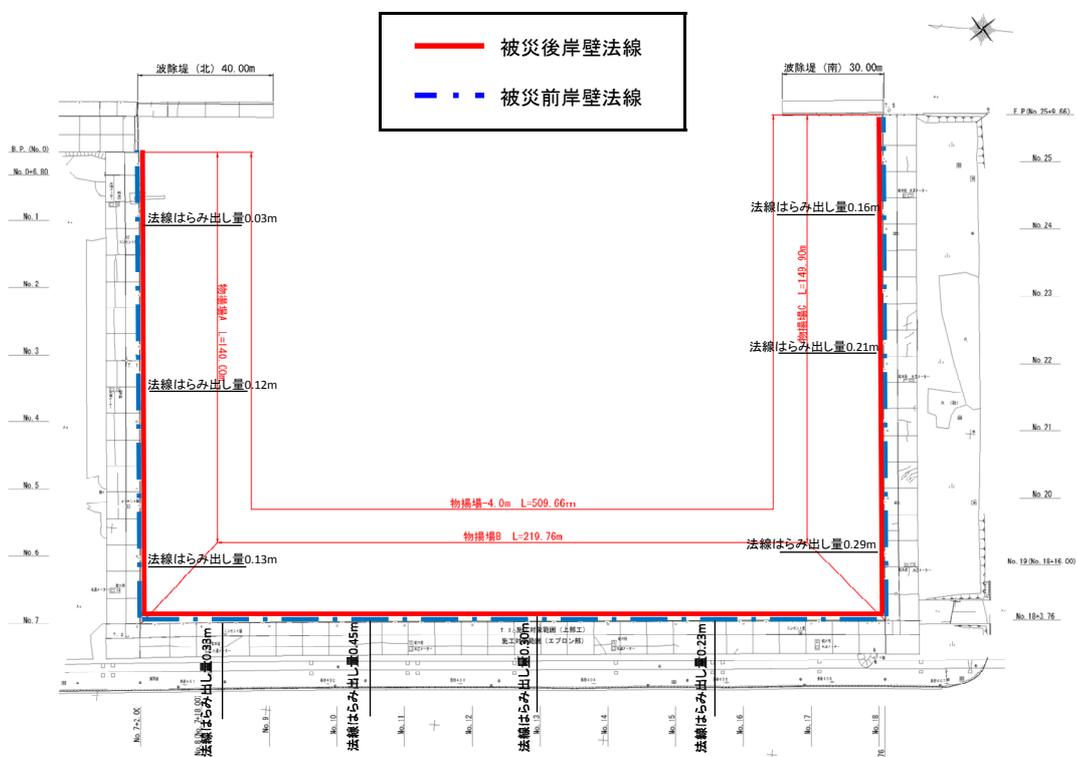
No.19 常陸那珂港区_北ふ頭地区物揚場 A,B,C の平面図 (被災後)
